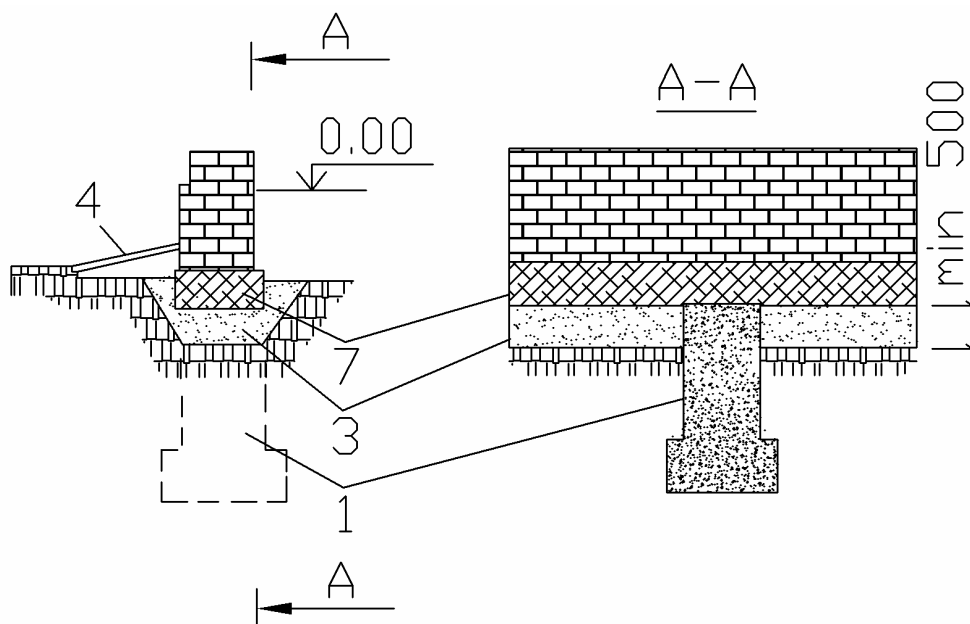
Столбчатые фундаменты малоэтажных зданий под каменные стены:
